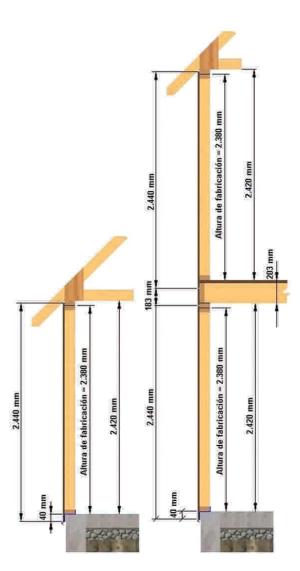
75: Altura de fabricación de tabiques con madera cepillada sobre plataforma de hormigón para el caso de viviendas de 10 2 pisos sin considerar solera basal de montaje
